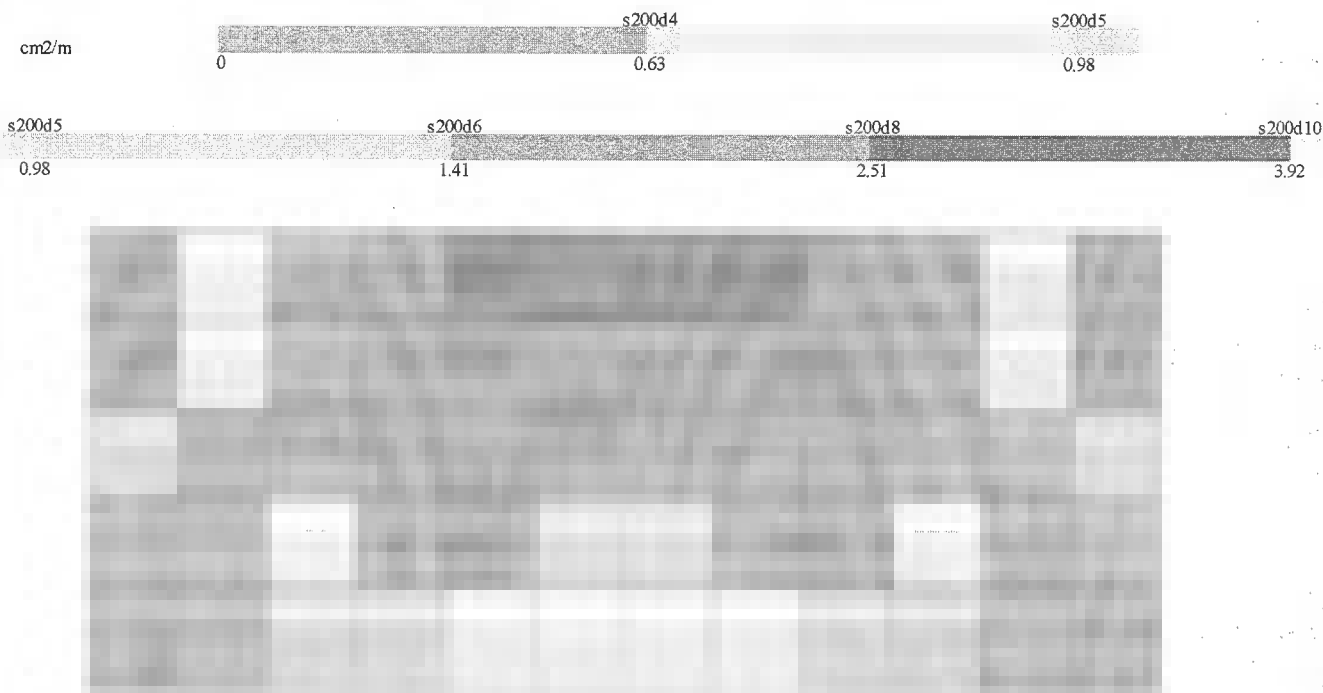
Армирование стены L= 6м вдоль оси X внешняя грань
